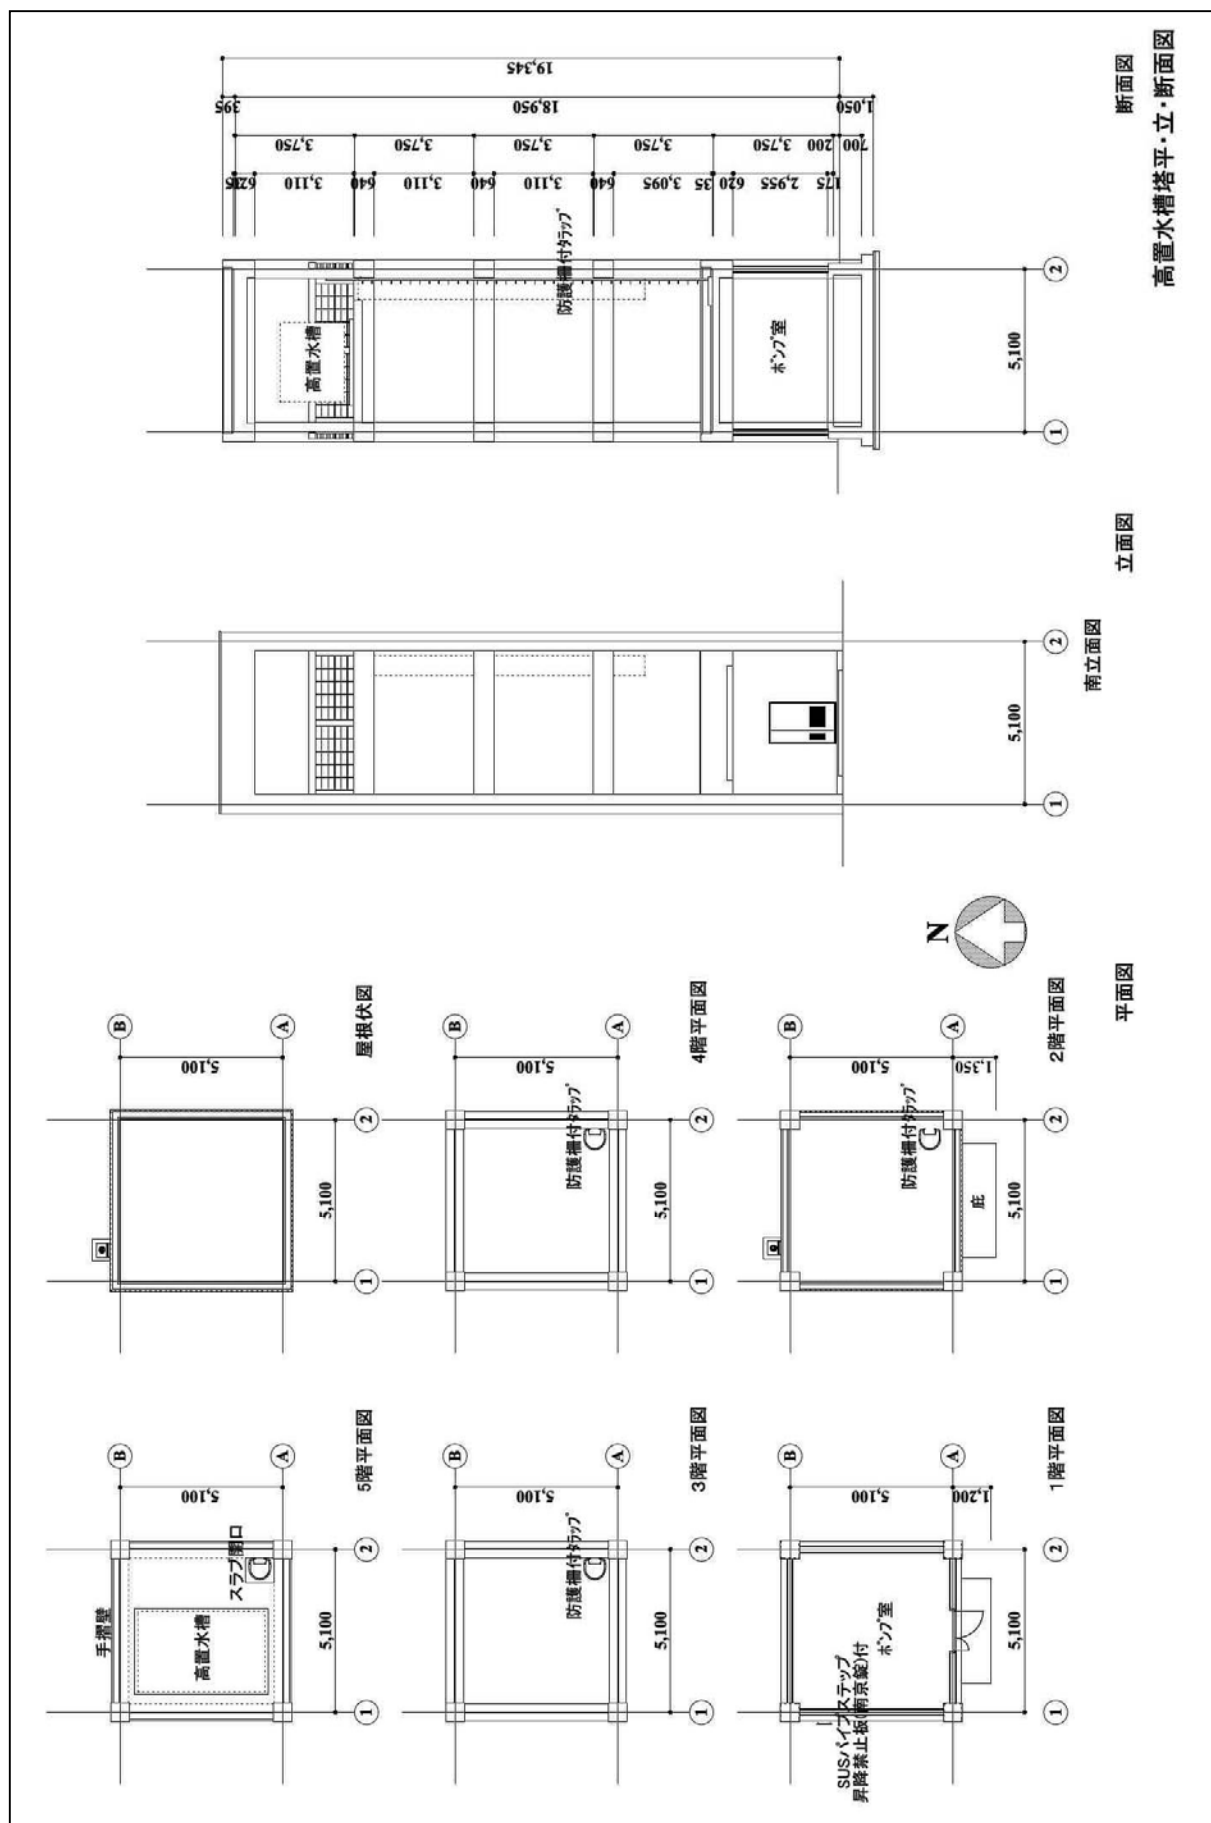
(11) 高置水槽塔（平面・立面・断面図）
